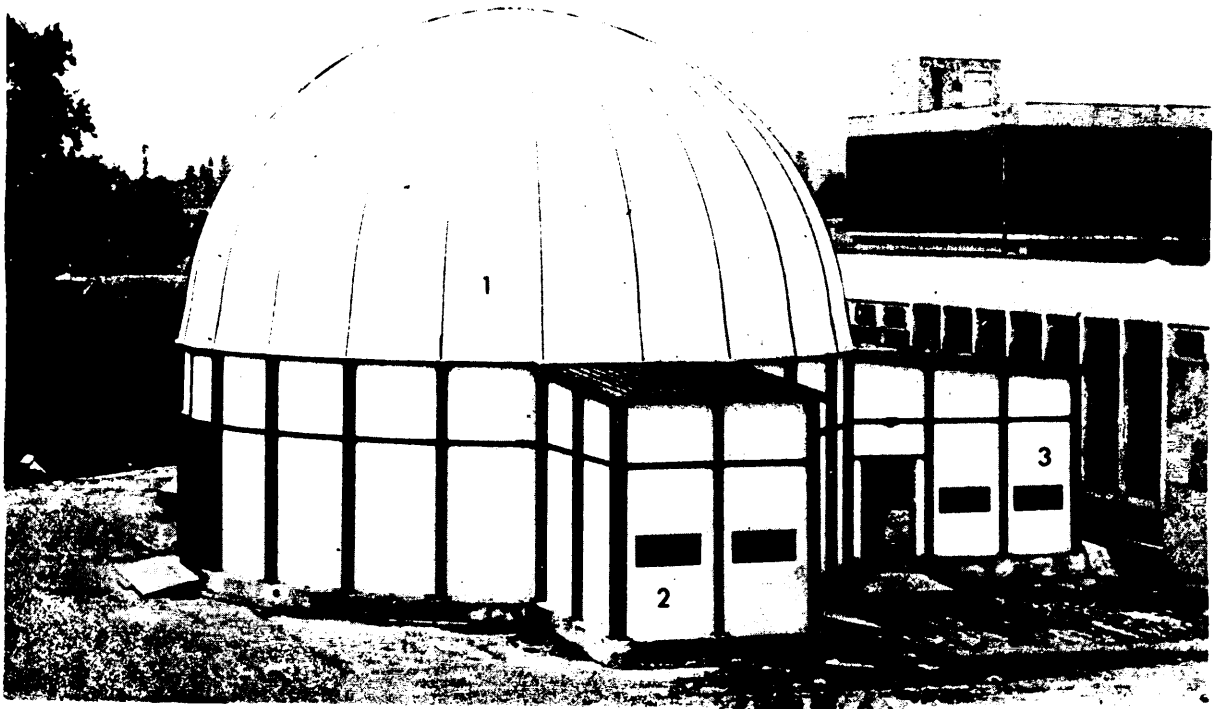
Essai Berthe - Hall d'essai HT construit par l'IPN de Lyon
